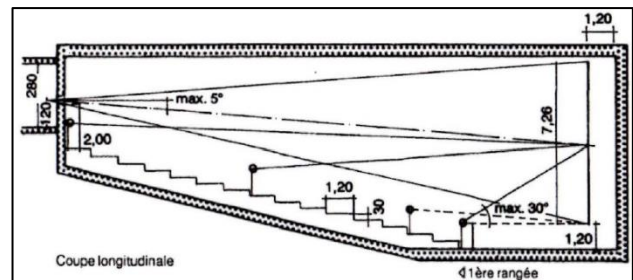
Coupe longitudinale d'une salle de cinéma, (source : Neufert 10^{ème} édition).
